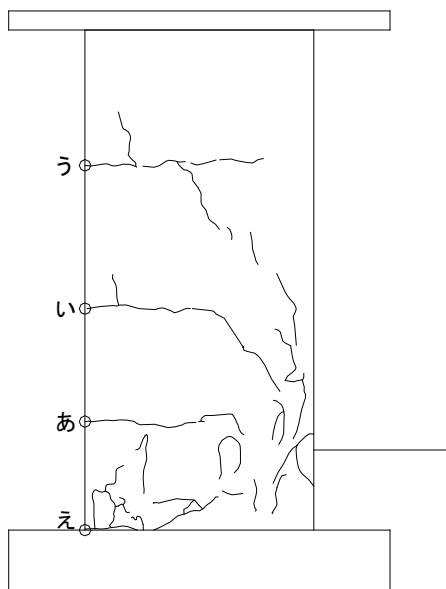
柱ひび割れ幅測定位置(試験体 A-5 正載荷)
